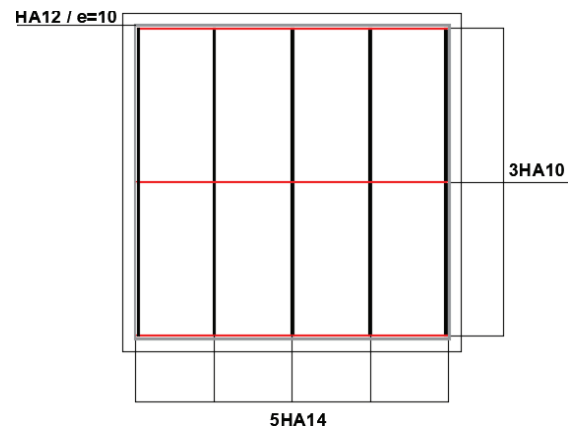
Croquis de ferrailage du dés d'appuis vue en plan (supérieure).
